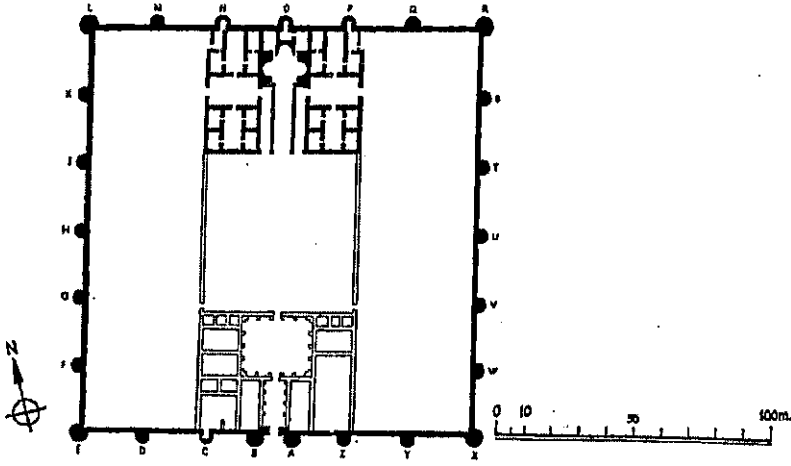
مسقط أفقي لقصر الأخيضر عن:
